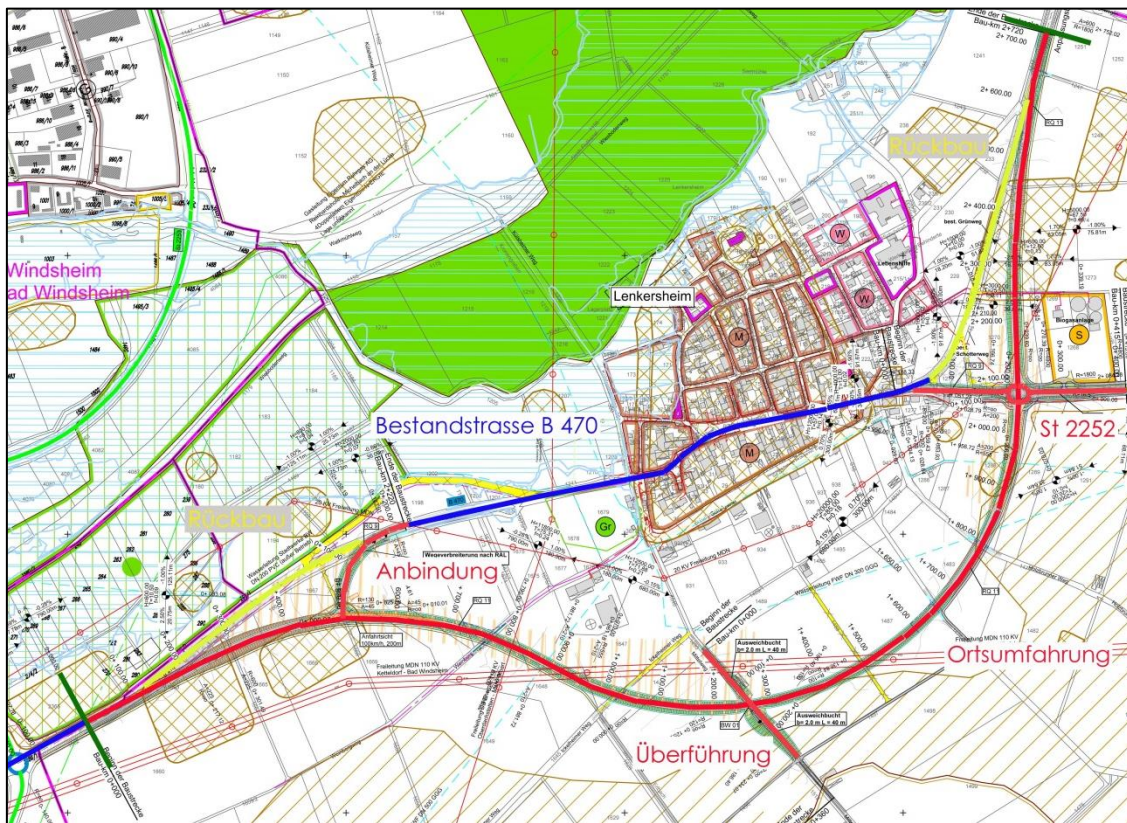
Lageplan mit Darstellung der geplanten Ortsumfahrung von Lenkersheim /10/
